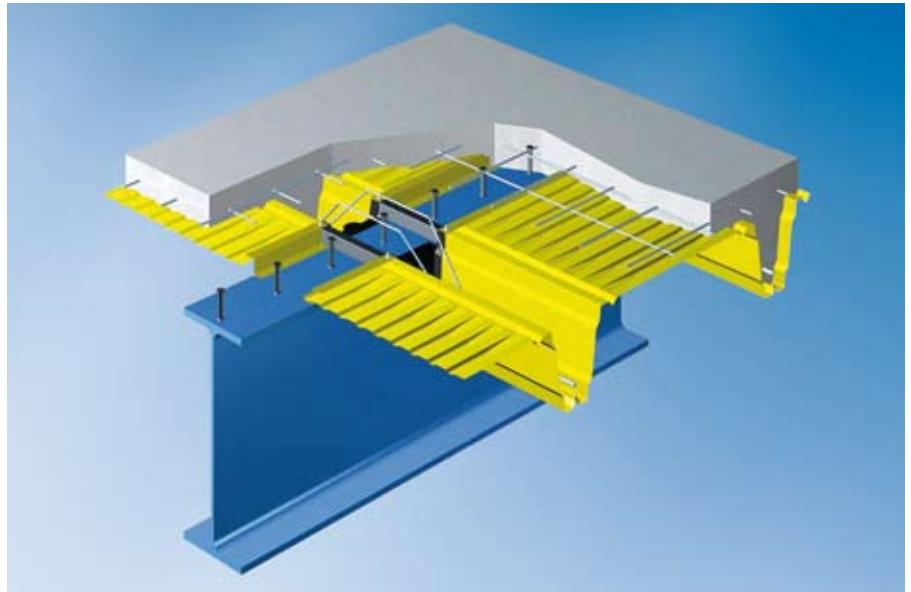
Aanblik van de Cofradal vloer voordat de betonnen druklaag is gestort.
